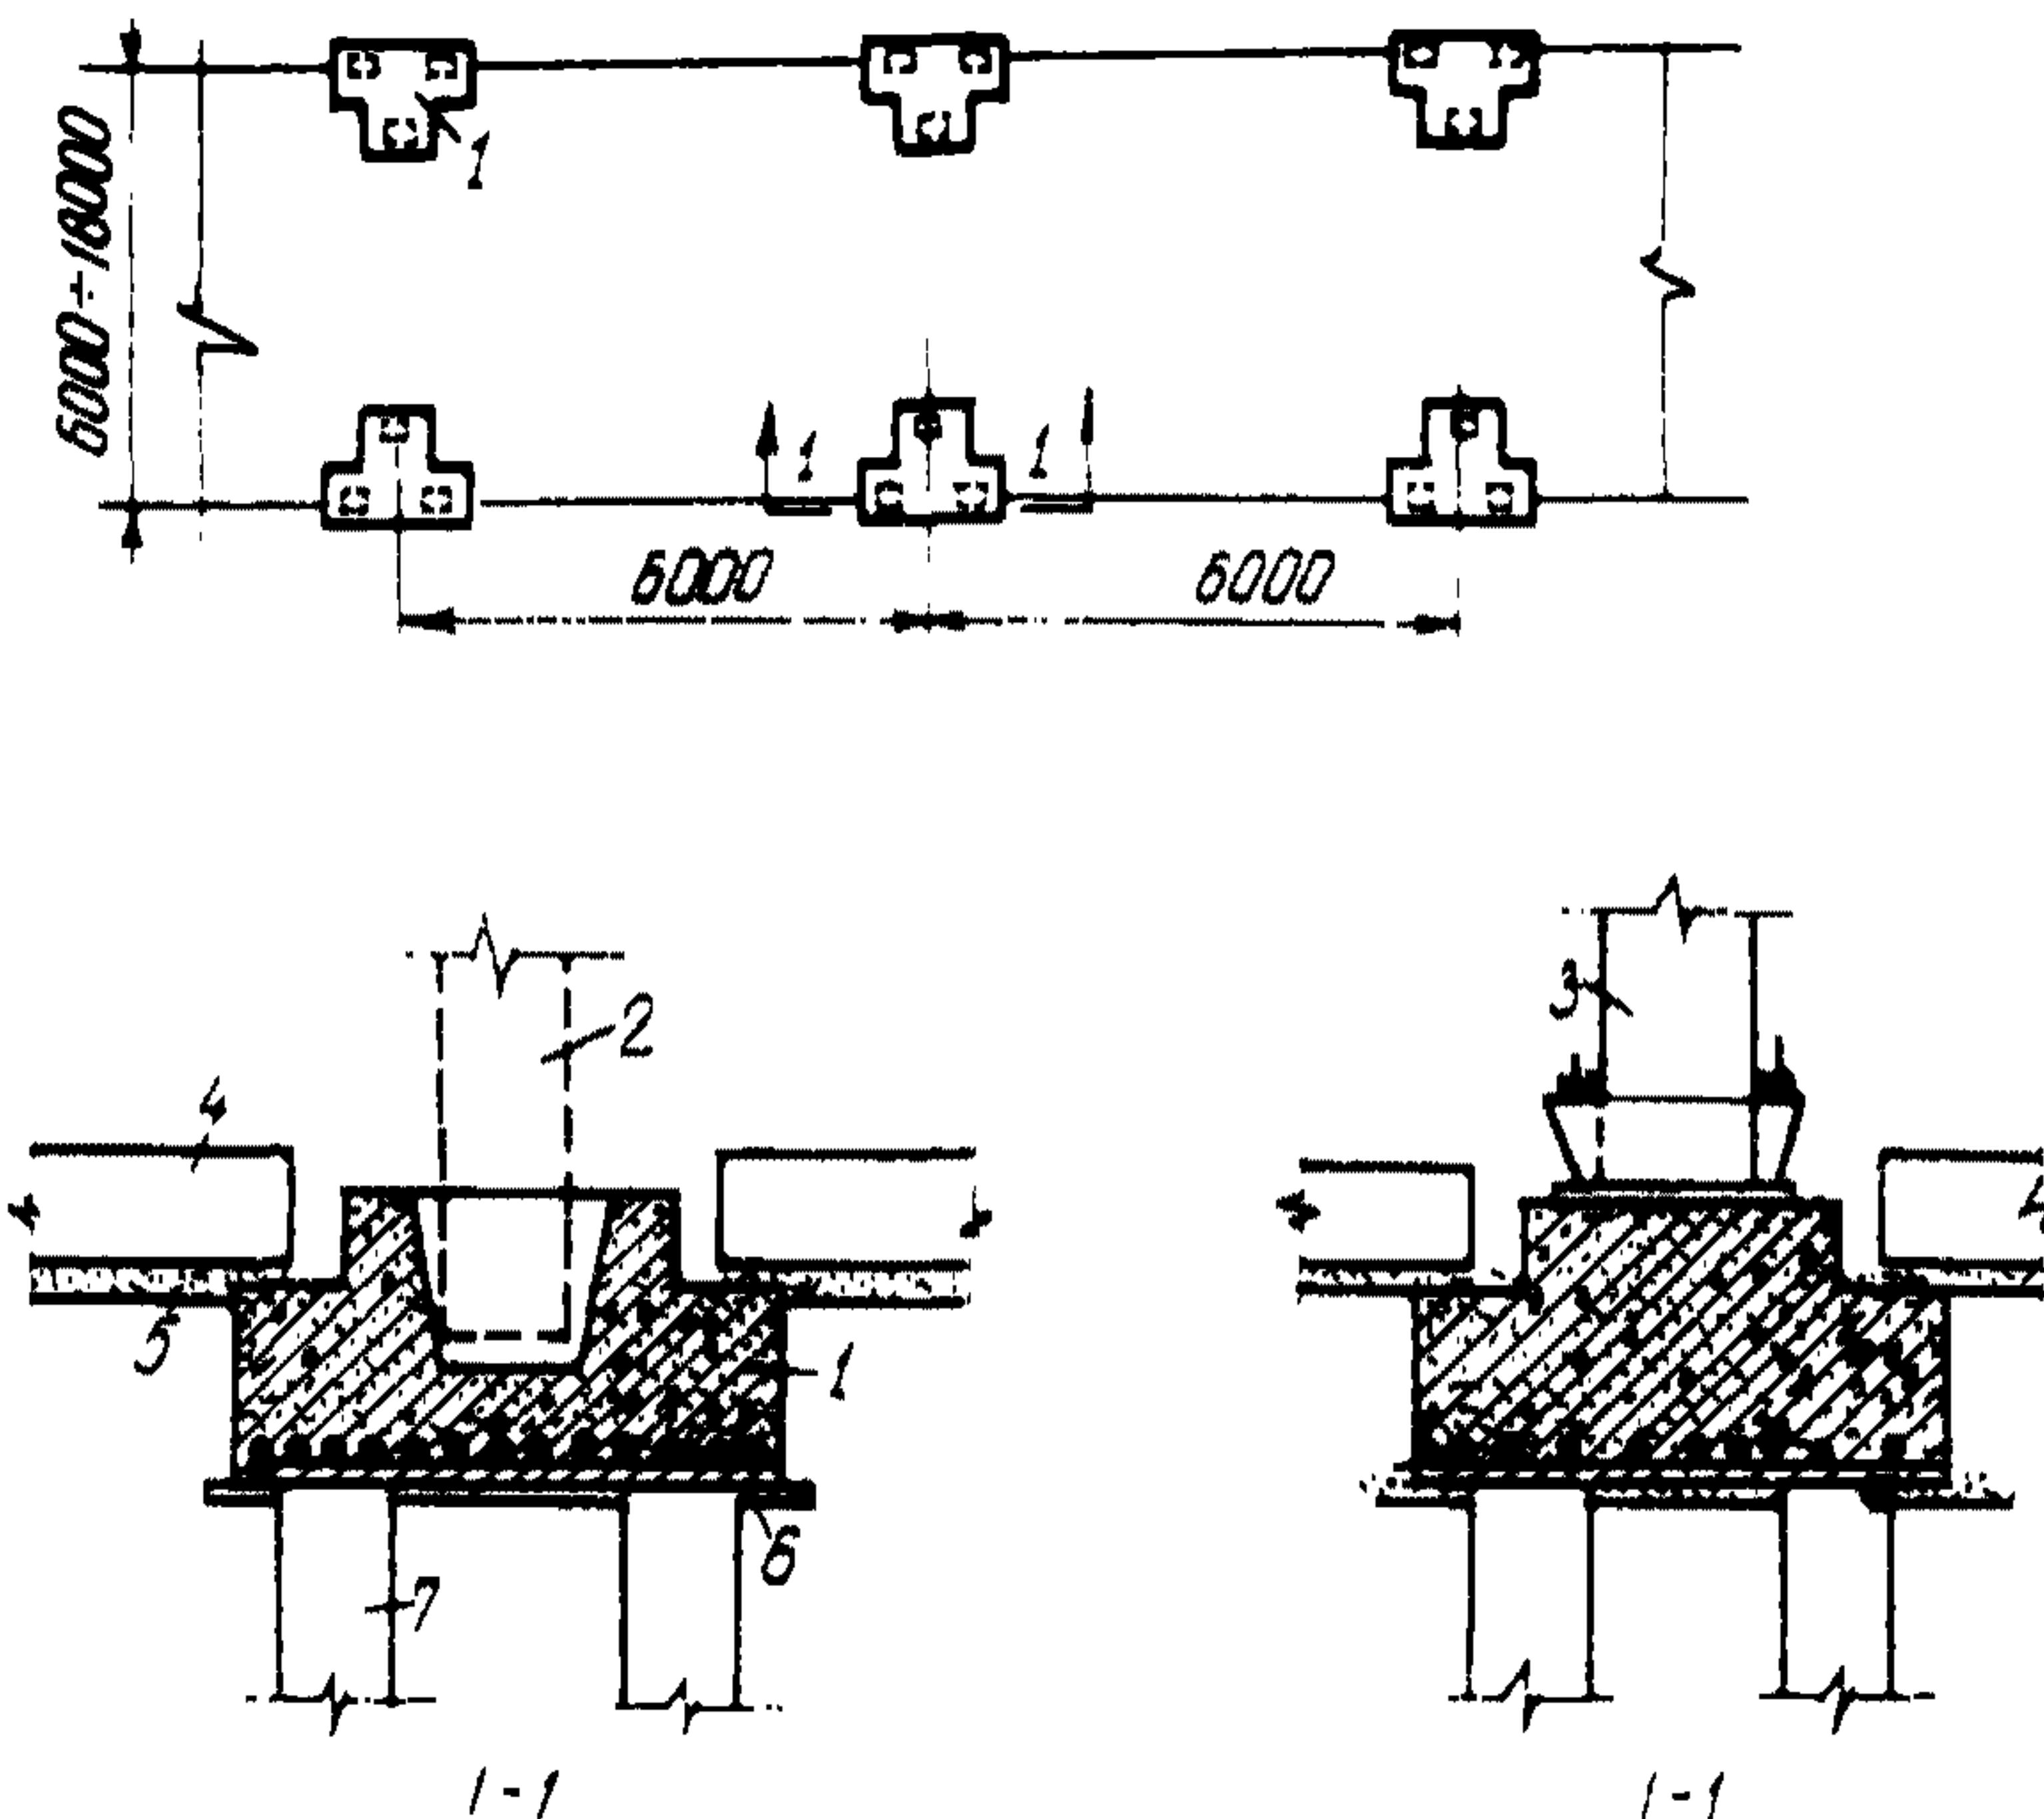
Свайные фундаменты с монолитными ростверками под железобетонный и стальной каркасы зданий:
